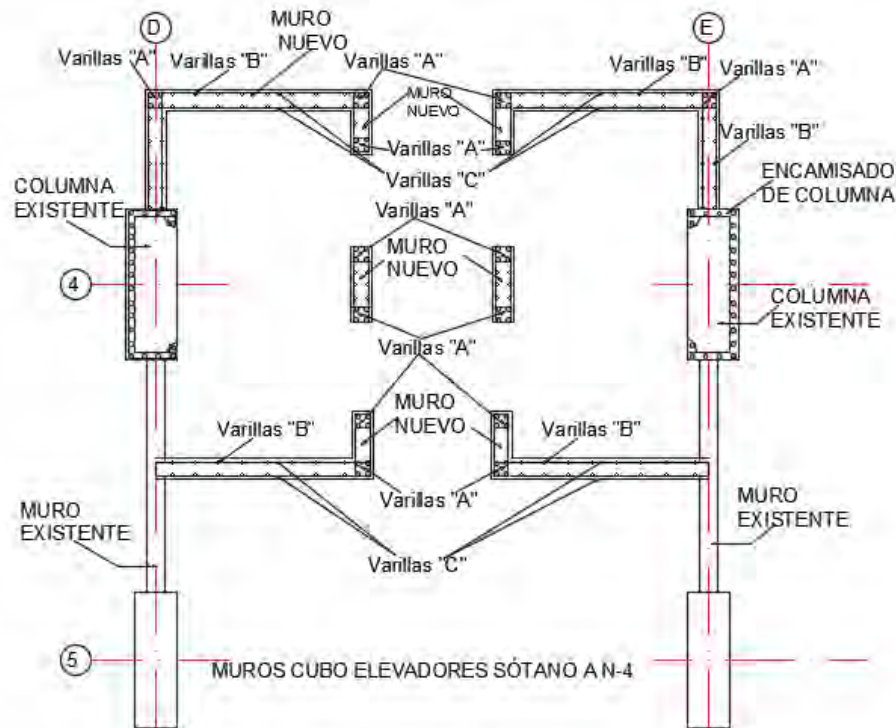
Muros de concreto reforzado en cubos de elevadores del sótano al nivel 4
